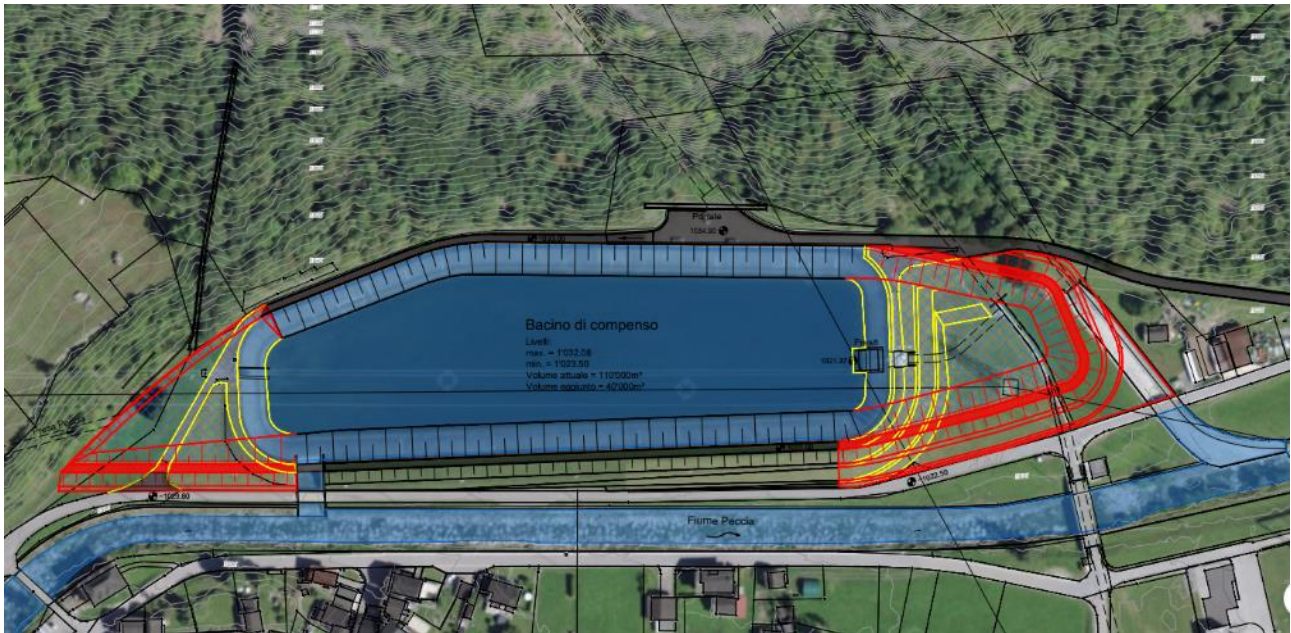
Estratto piano interventi a Piano di Peccia. In rosso i nuovi elementi.
